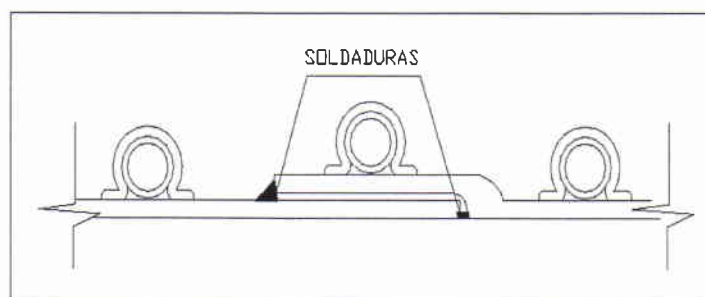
Uniones soldadas por aporte, entre tubos Spiropecc.
